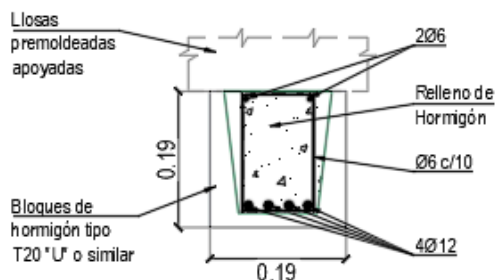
VIGAS SOBRE PB | ESQUEMAS
